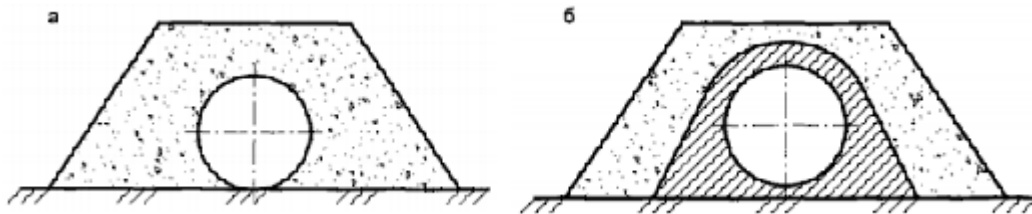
Наземная схема укладки : а- с обсыпкой минеральным грунтом; б- с обсыпкой гидрофобизированным грунтом.
